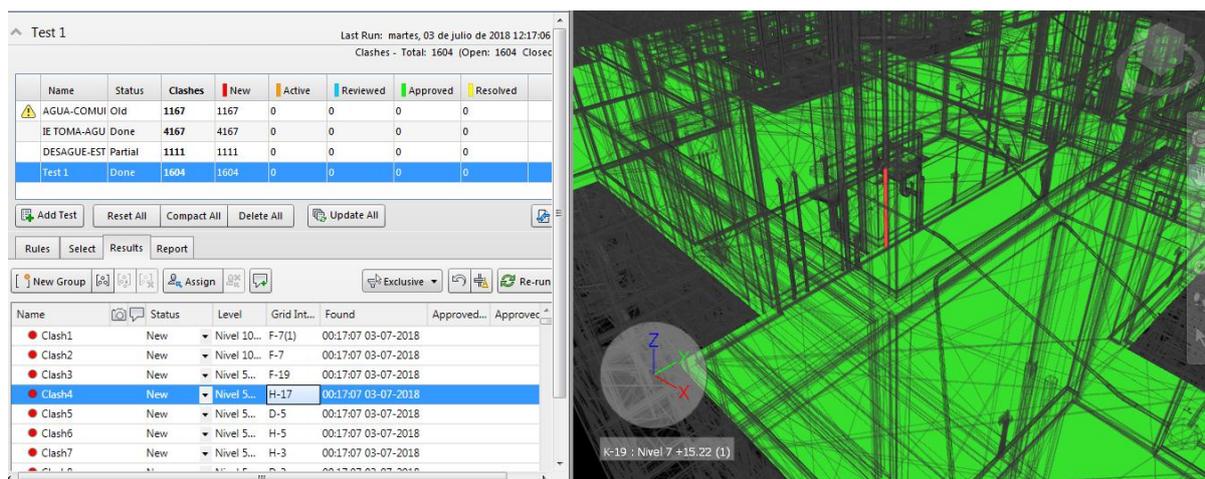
Interferencia entre losa de concreto y montante de ventilación del proyecto Construcción de la Torre II del Condominio Paseo San Martín
